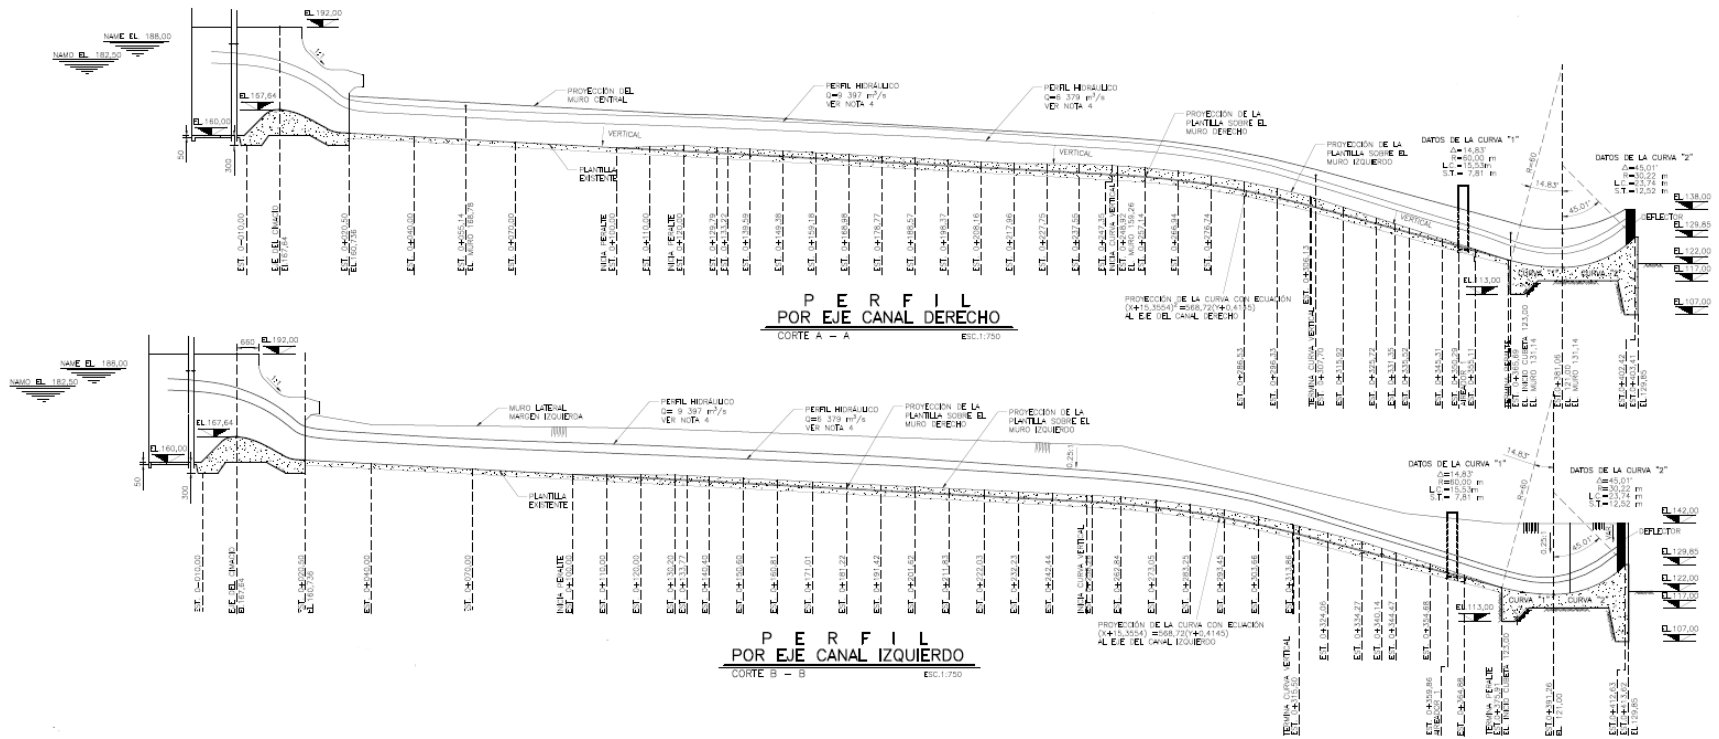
Planta del vertedor de emergencia presa Netzahualcóyotl (SDH)
